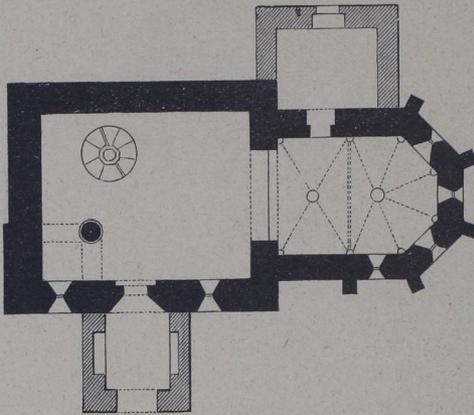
Grundriss der Kirche in Libisch.
